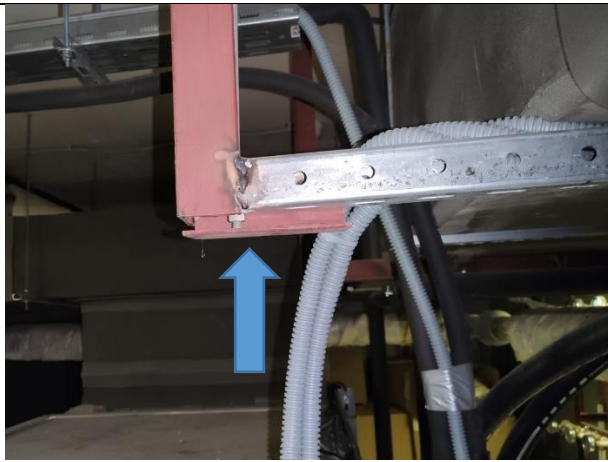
Сварные соединения не покрыты антикоррозионным покрытием
